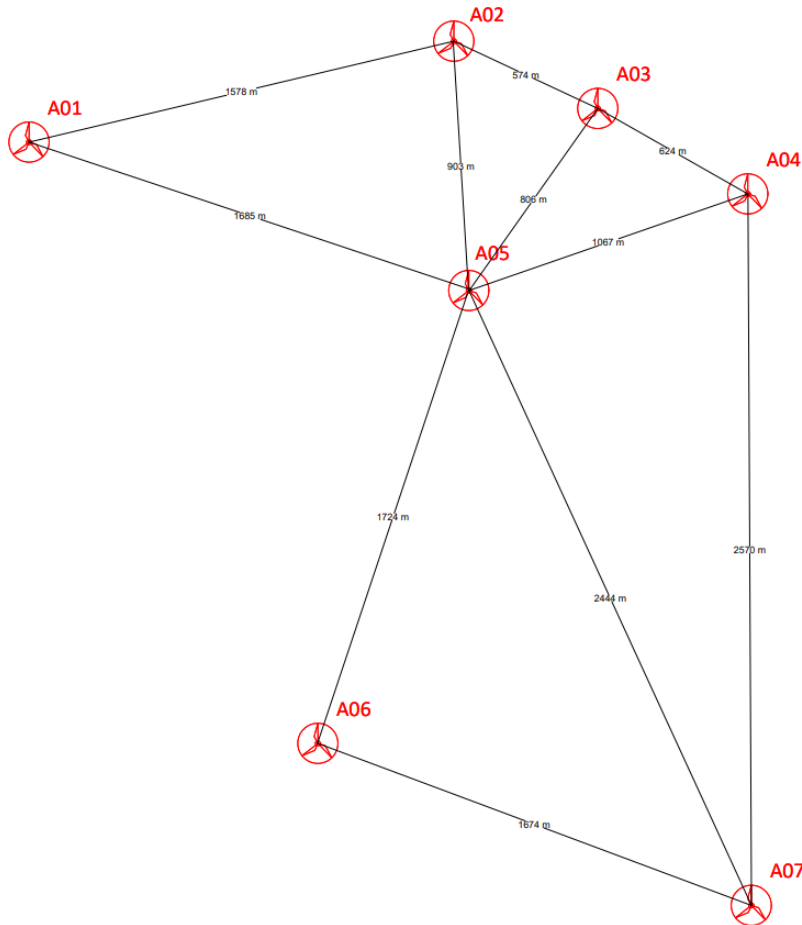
Schema layout con indicazione delle interdistanze tra le turbine di progetto
